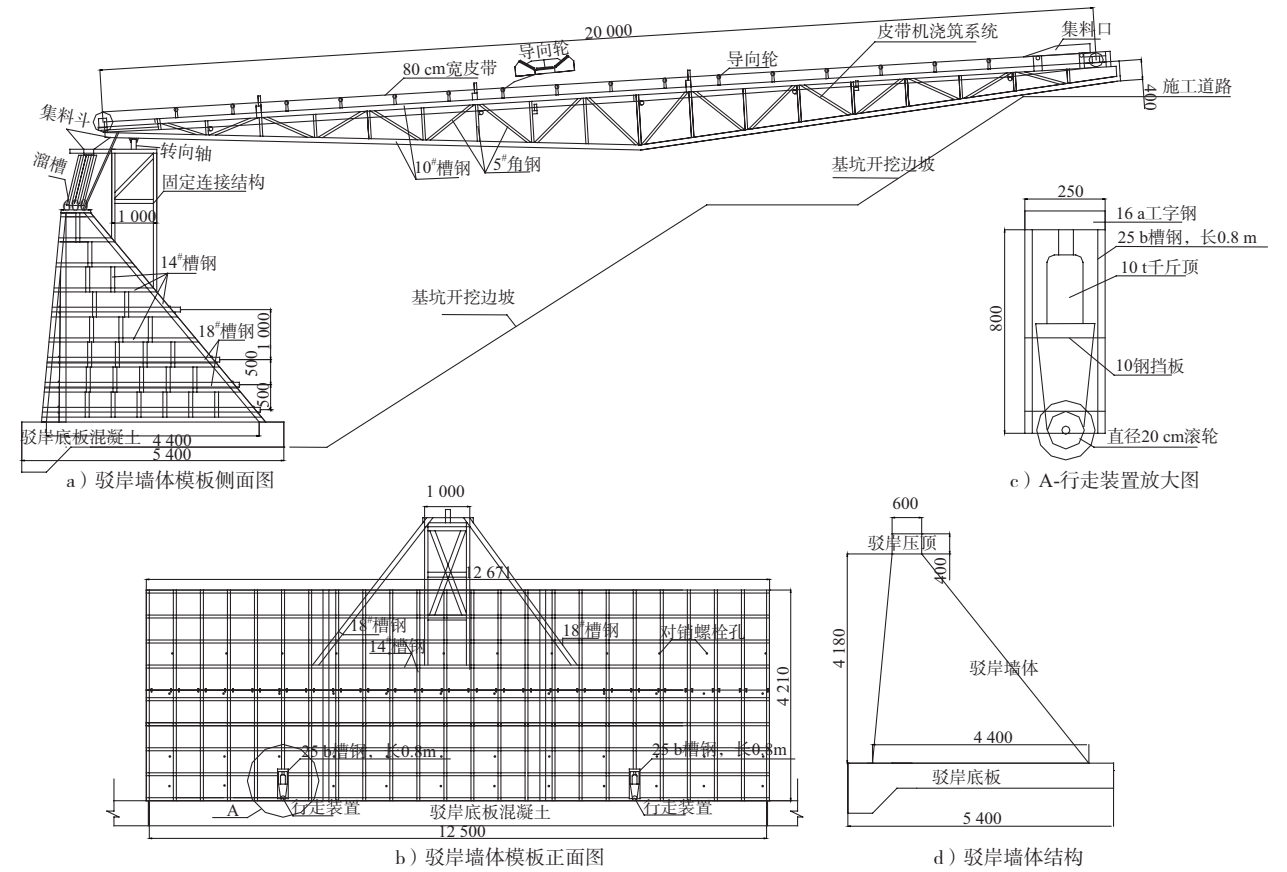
混凝土直立式驳岸快速施工浇筑系统（单位：mm）
